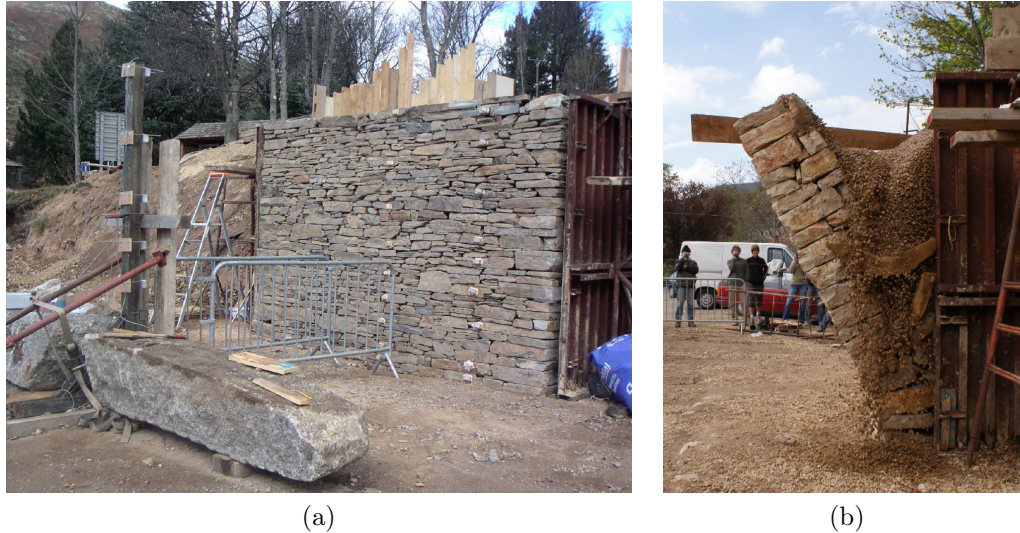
Campagne expérimentale sur murs en pierre sèche à l'échelle 1 : dispositif expérimental du mur C2s (a) et renversement du mur C4c (b).
